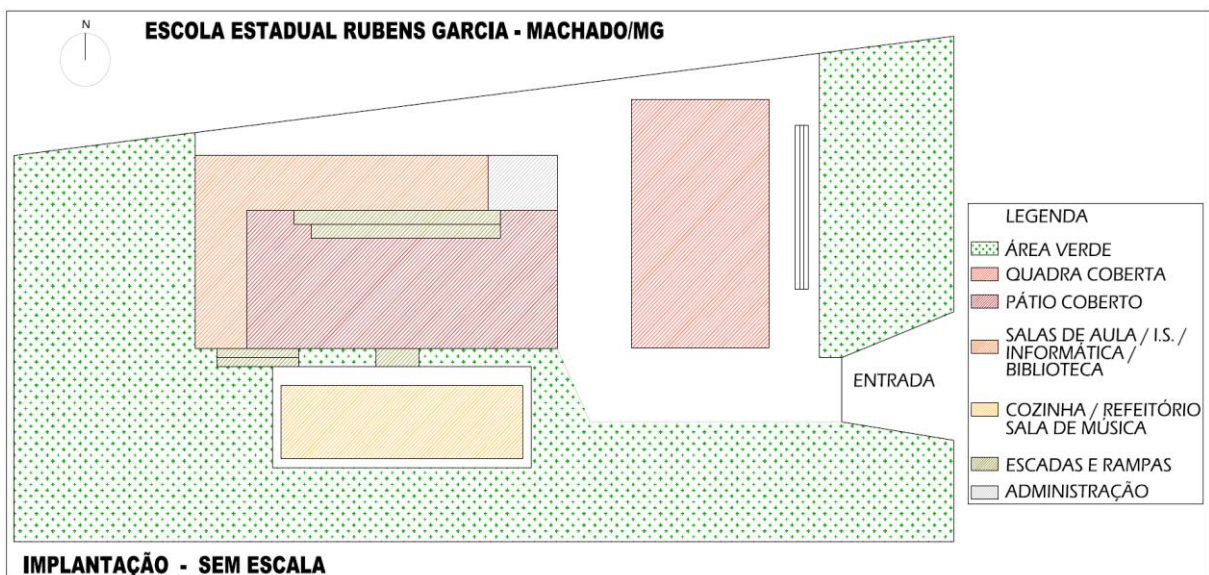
Planta de implantação da Escola Estadual Rubens Garcia.
